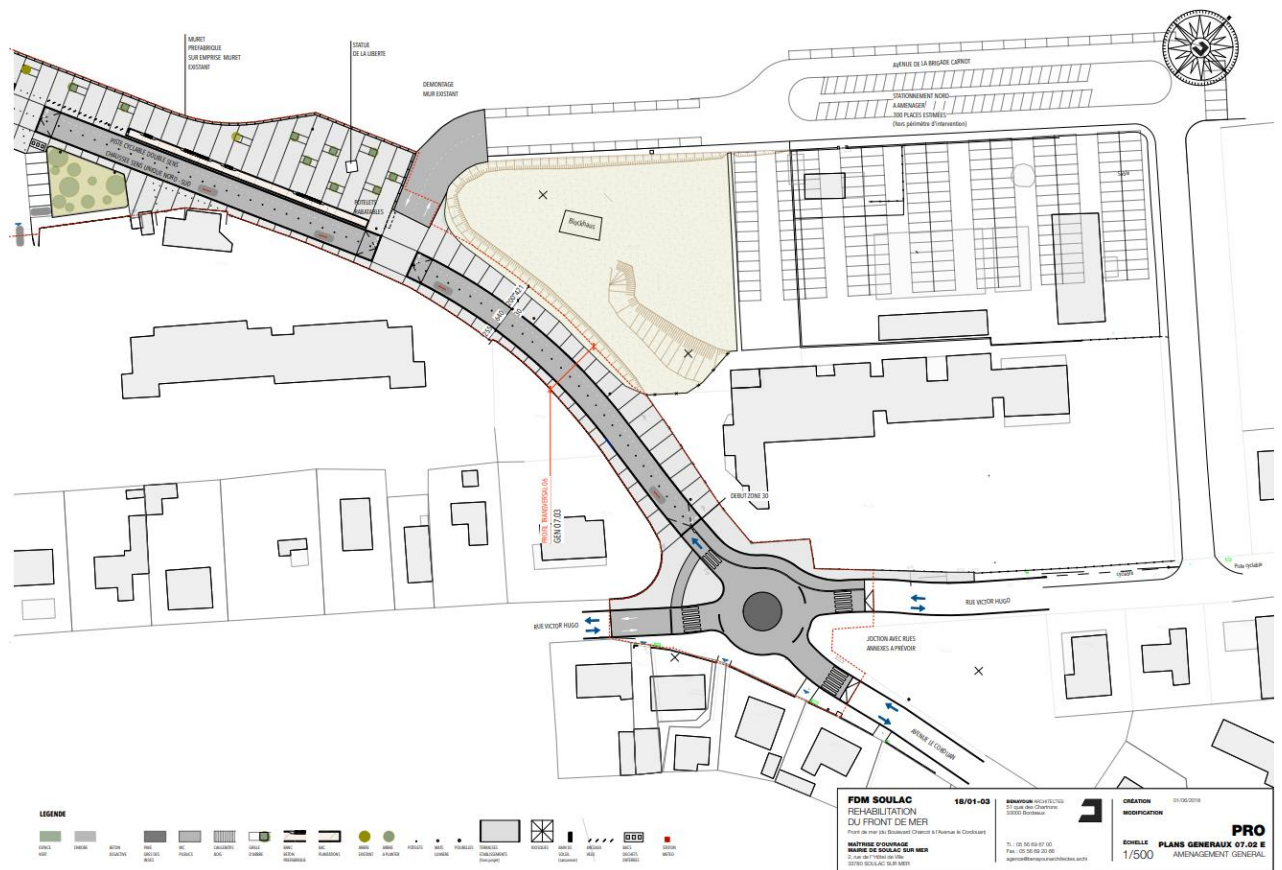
Plans de l'aménagement projeté (portion 5) (Source : PRO –juin 2018)
